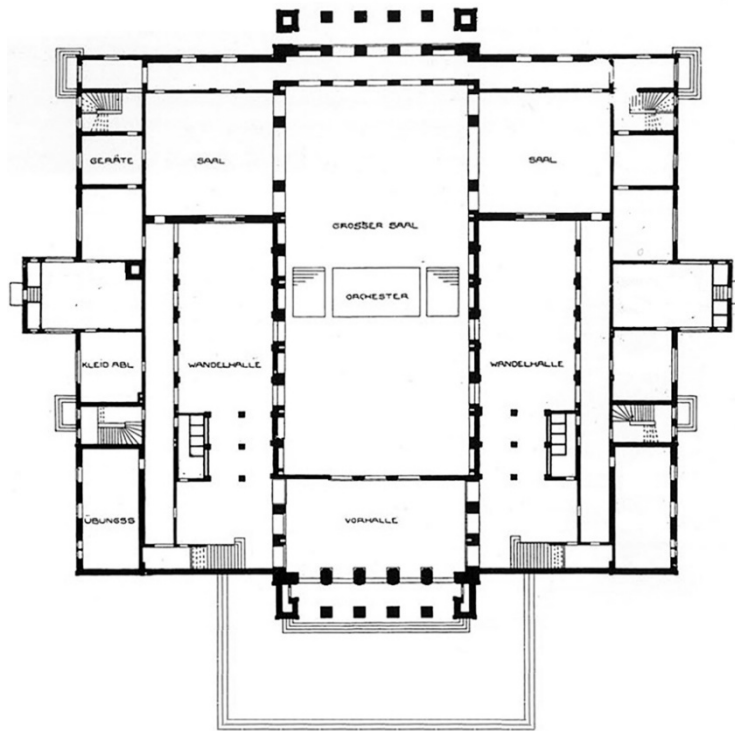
Heinrich Tessenow, plan du rez-de-chaussée de l'Institut Jaques-Dalcroze, 1911.
